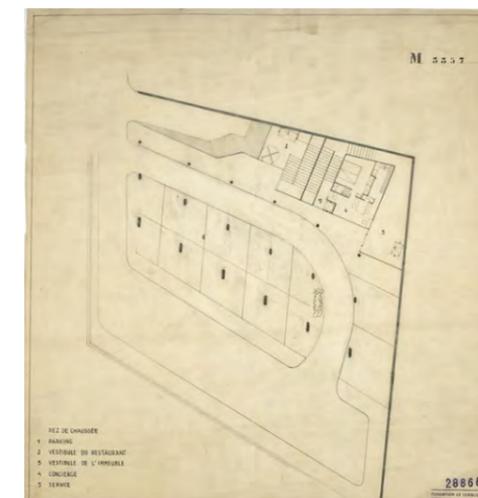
FLC 28866: Planta baja del Edificio en Montmartre.
